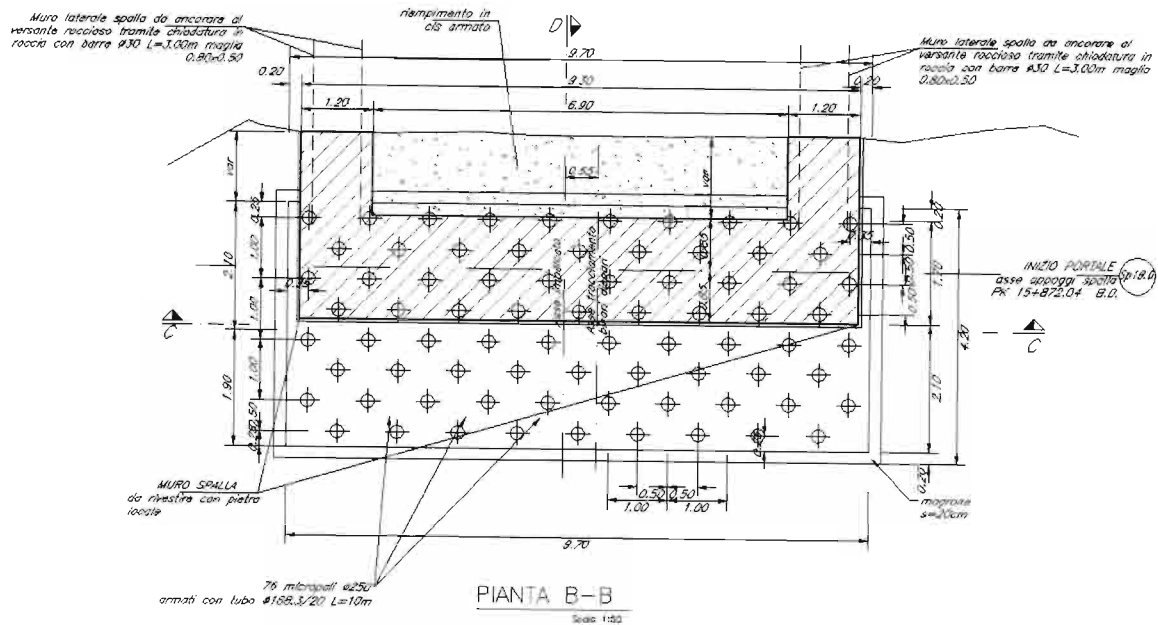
Pianta della spalla lato Scaleres VI02 (B.D.)
